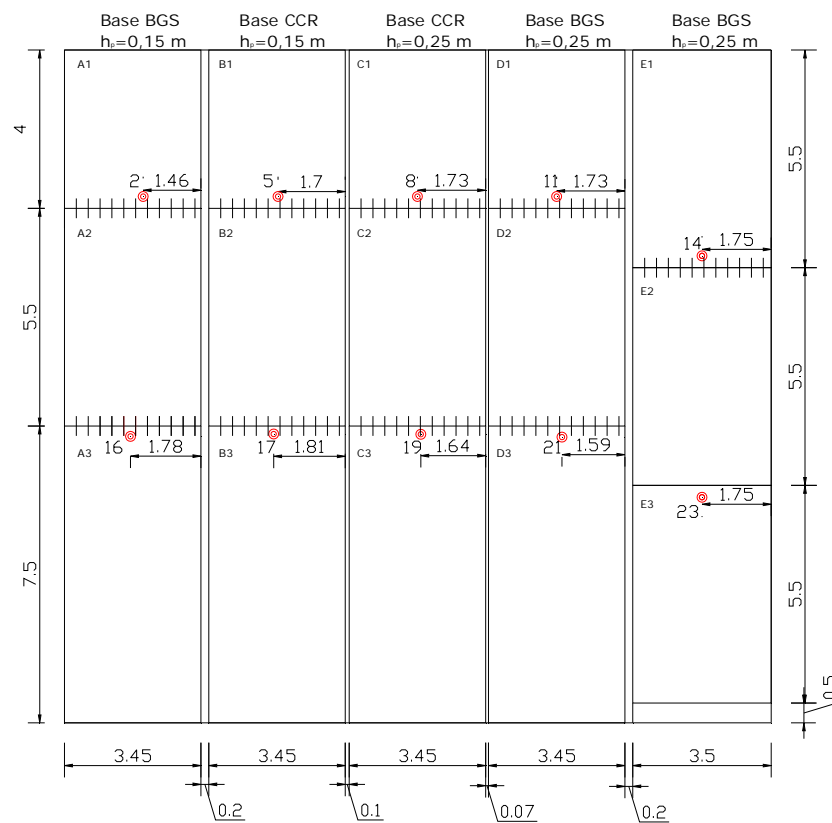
Posicionamento do prato de aplicação de carga na placa de concreto.
